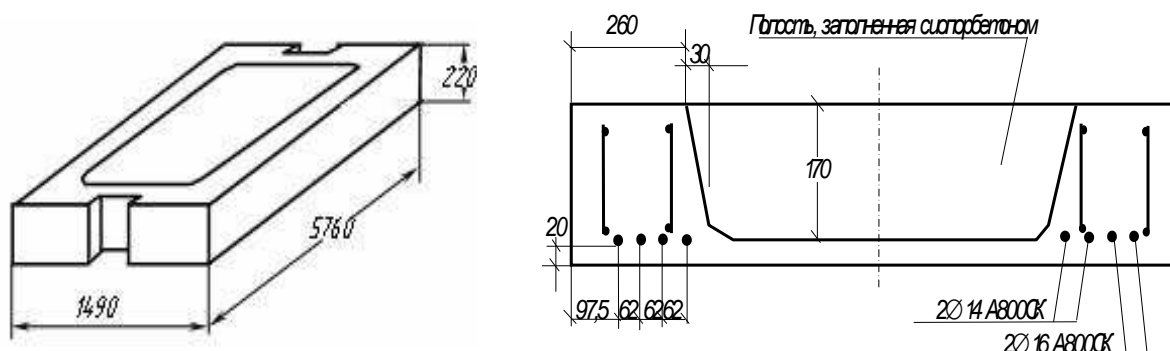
Конструктивная схема преднапряженной железобетонной плиты
